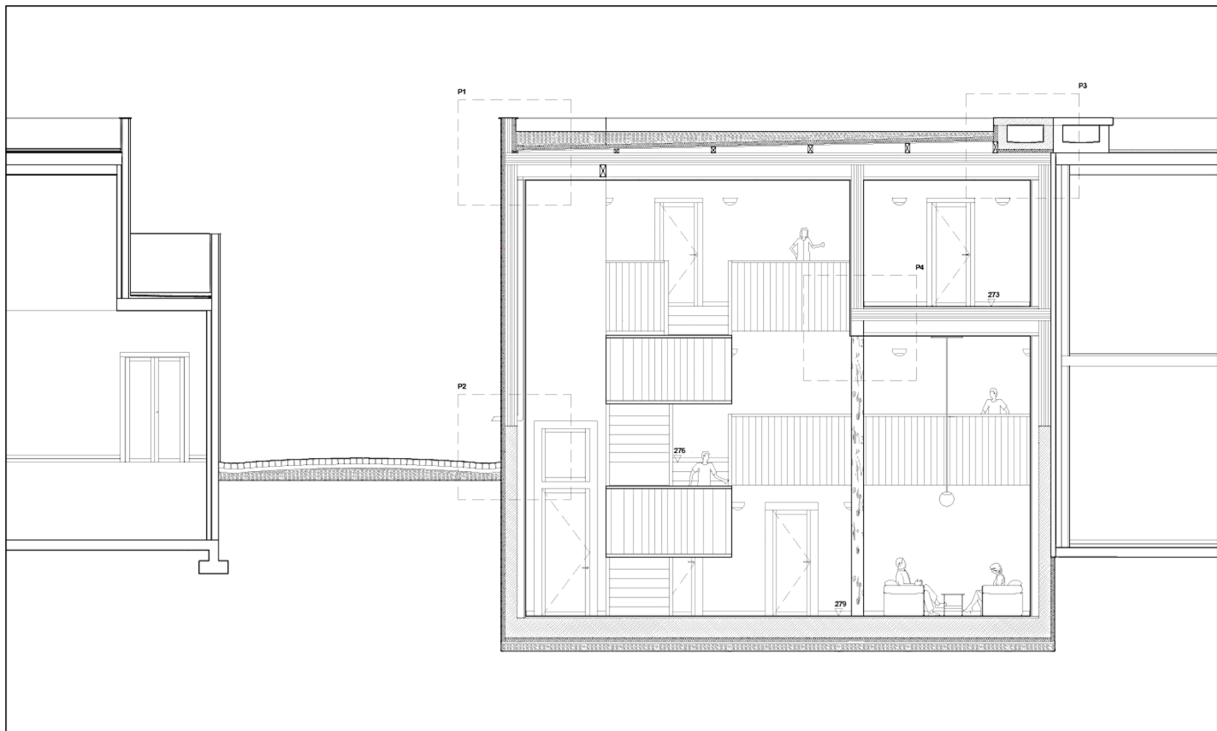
; Corte construtivo B do novo edifício (planta na figura 4.22).
